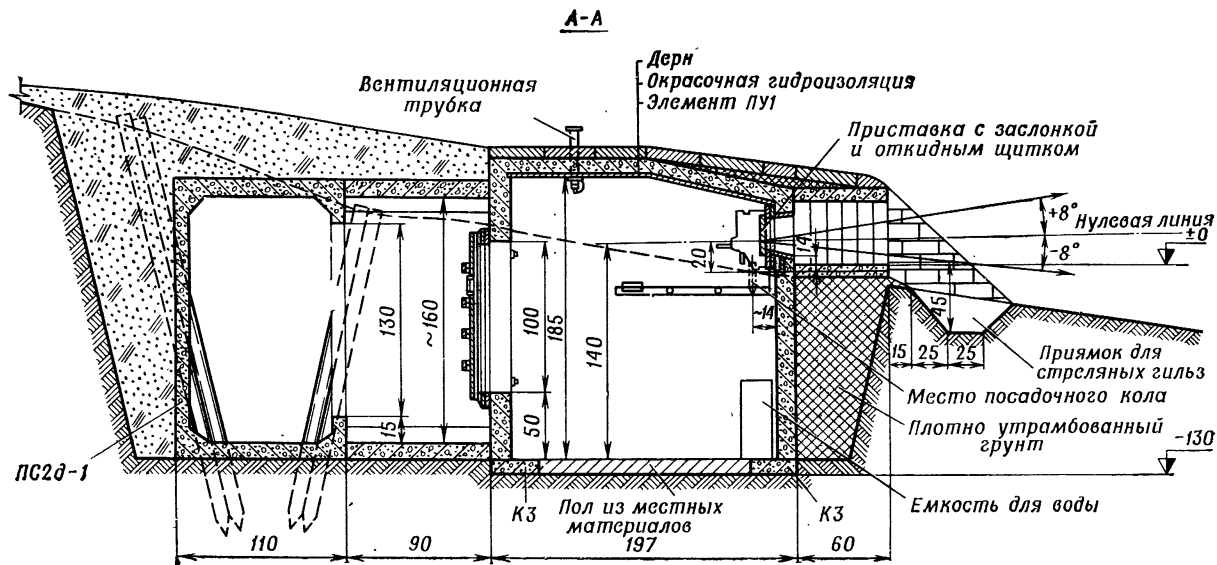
Сборное железобетонное пулеметное сооружение СПС-4
